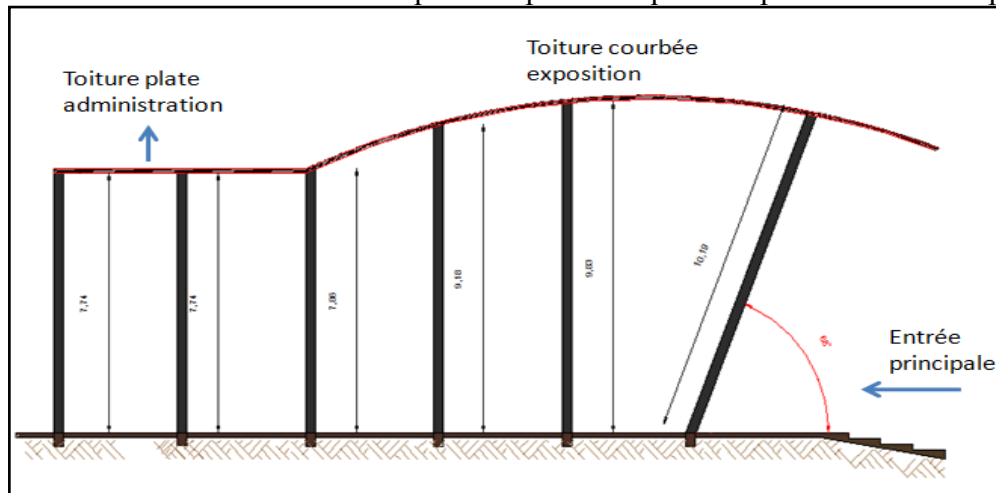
Coupe sur la toiture. Source : Elaborer par les auteurs
